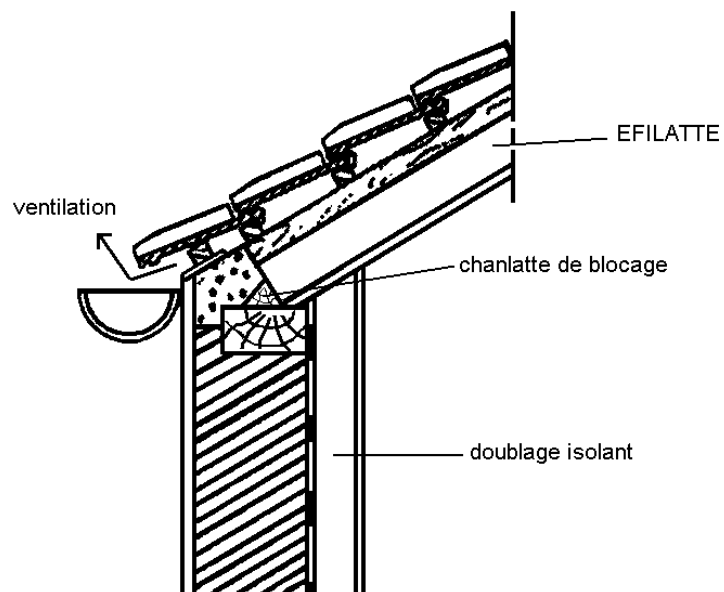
Finition en rive d'égout – Caisson en butée sur chanlatte
